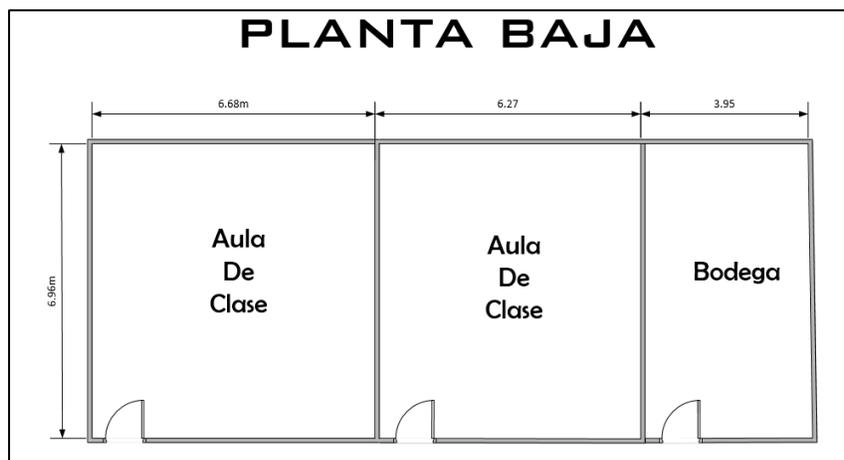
Plano de distribución Edificio Principal Planta Baja.
